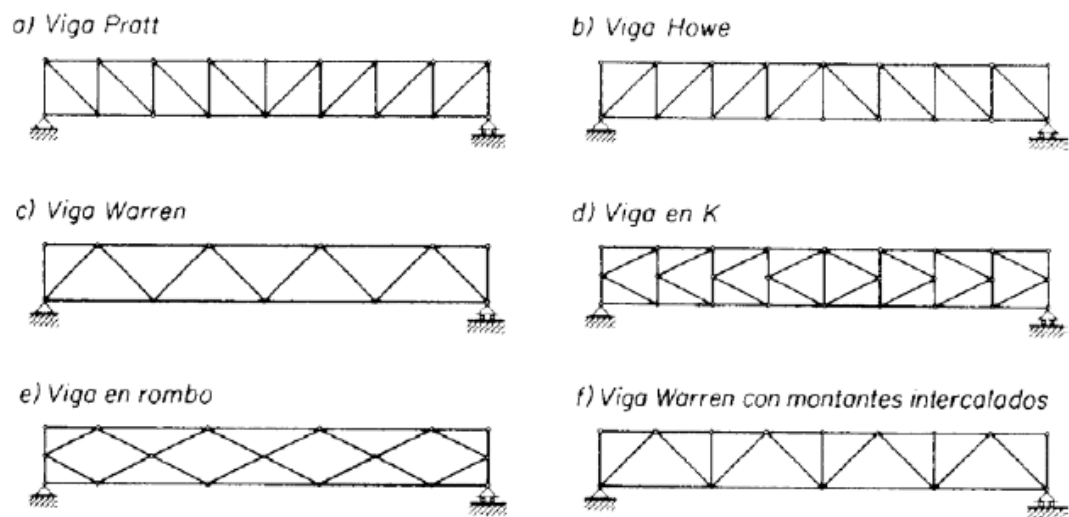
Tipos comunes de vigas en celosía de canto constante
